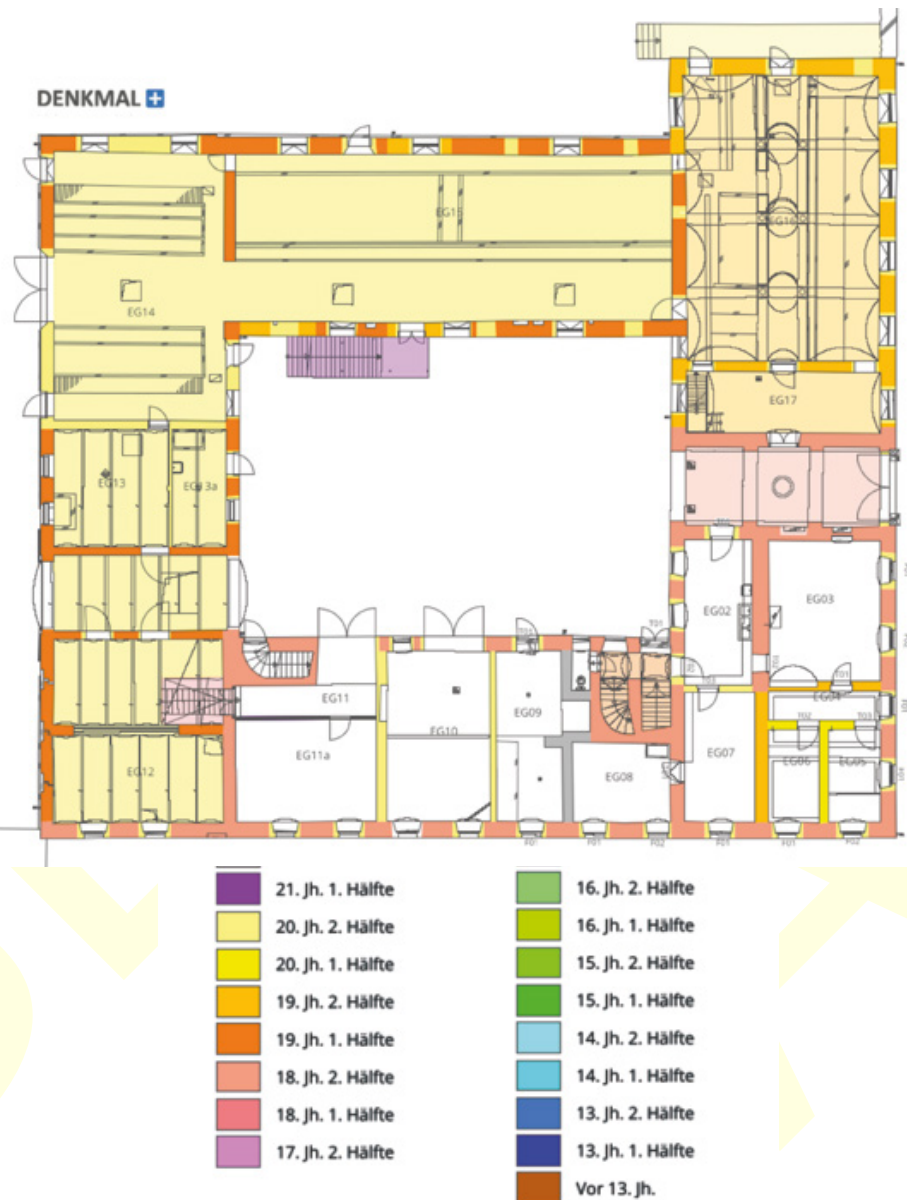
Urfahr, Leisenhof. Baualterplan des Erdgeschoßes.
